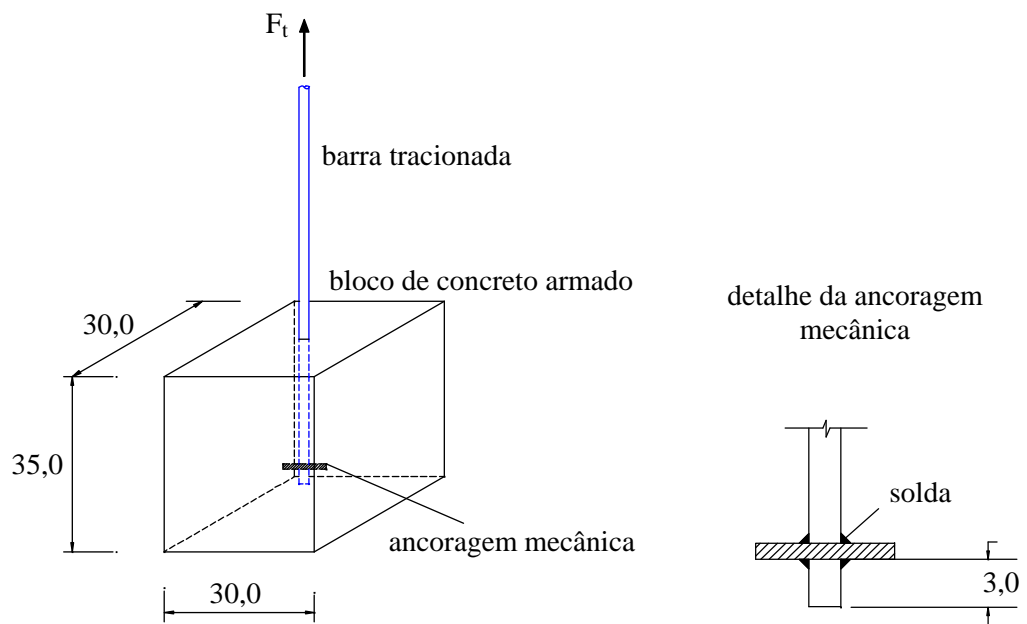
Modelo utilizado no ensaio de arrancamento (dimensões em cm).
